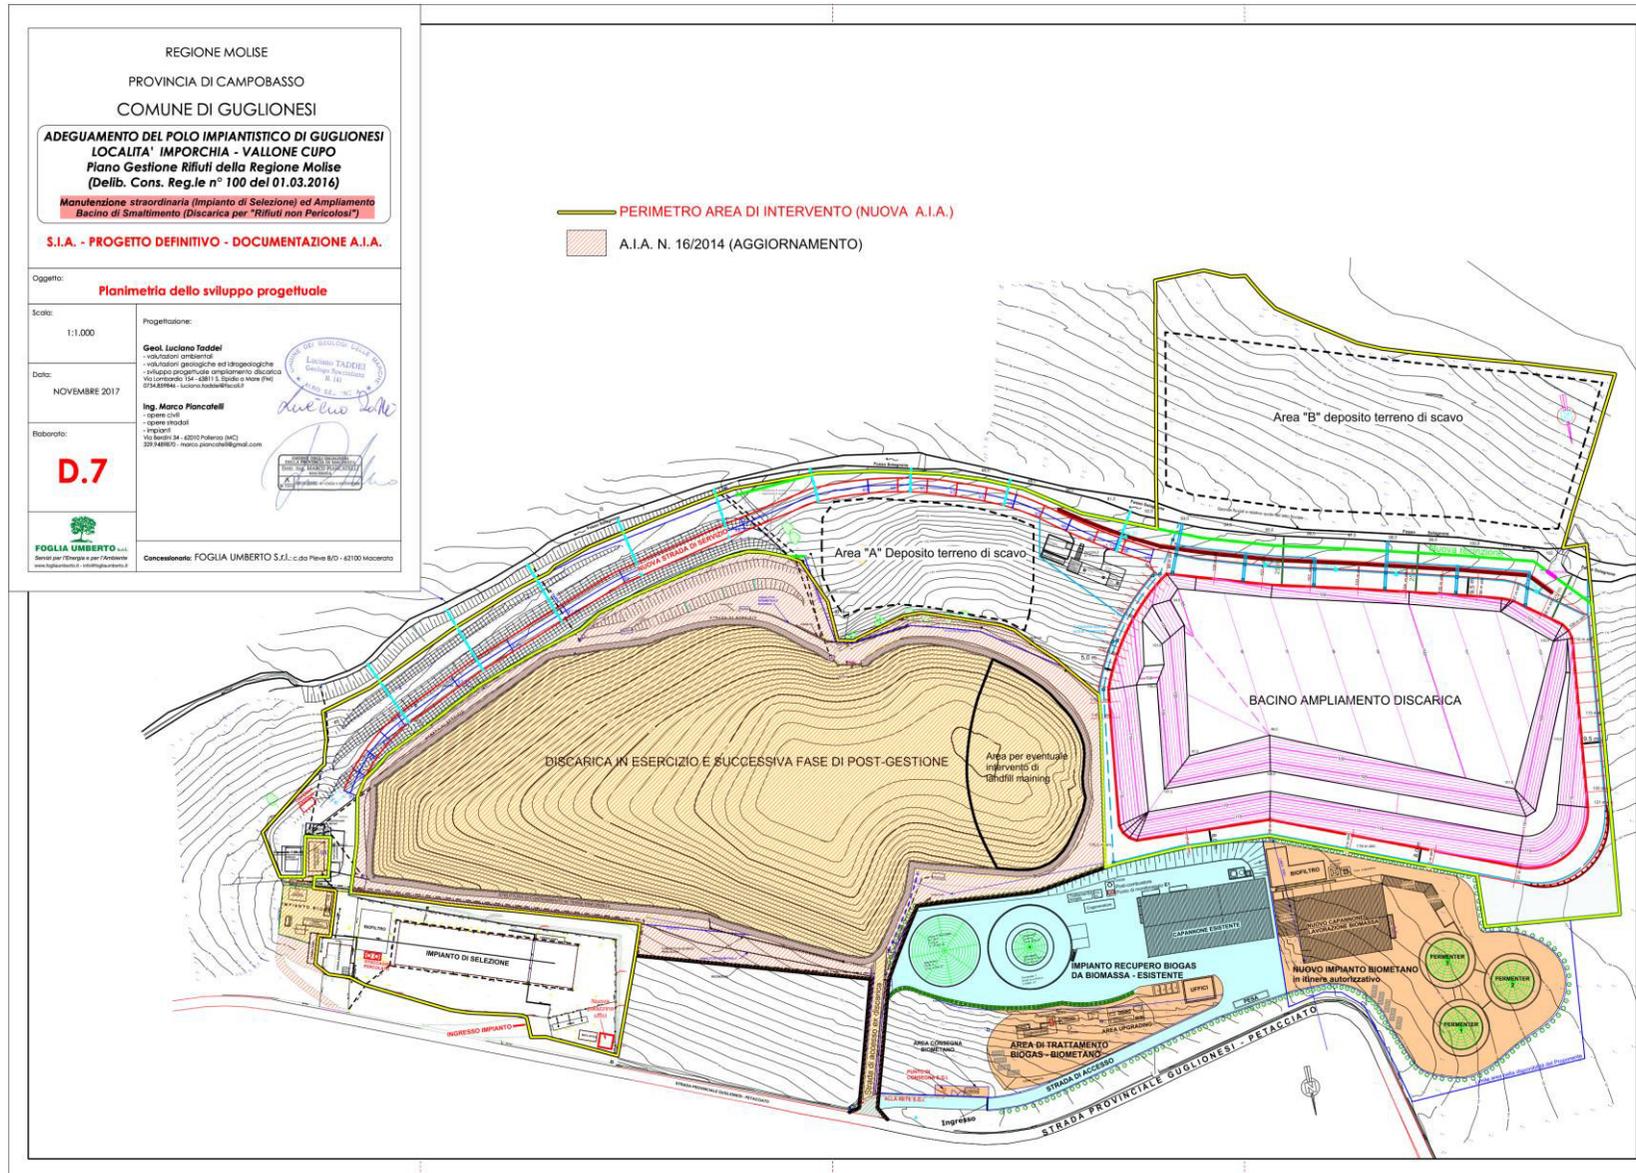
planimetria generale dell'intervento: assetto "post operam"
